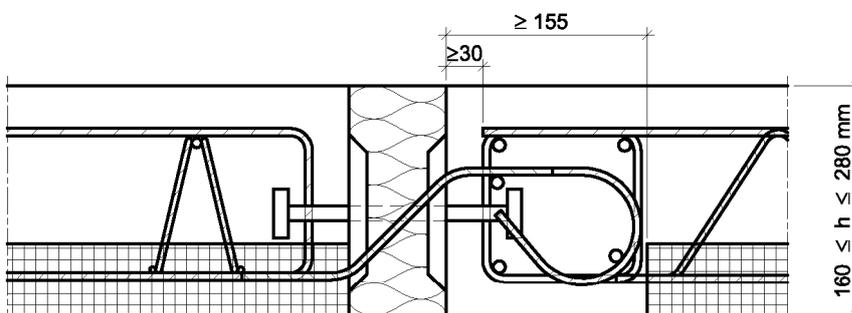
Beispiel Schöck Isokorb Typ Q (mit abgebogenem Querkraftstab) mit Elementplatten
